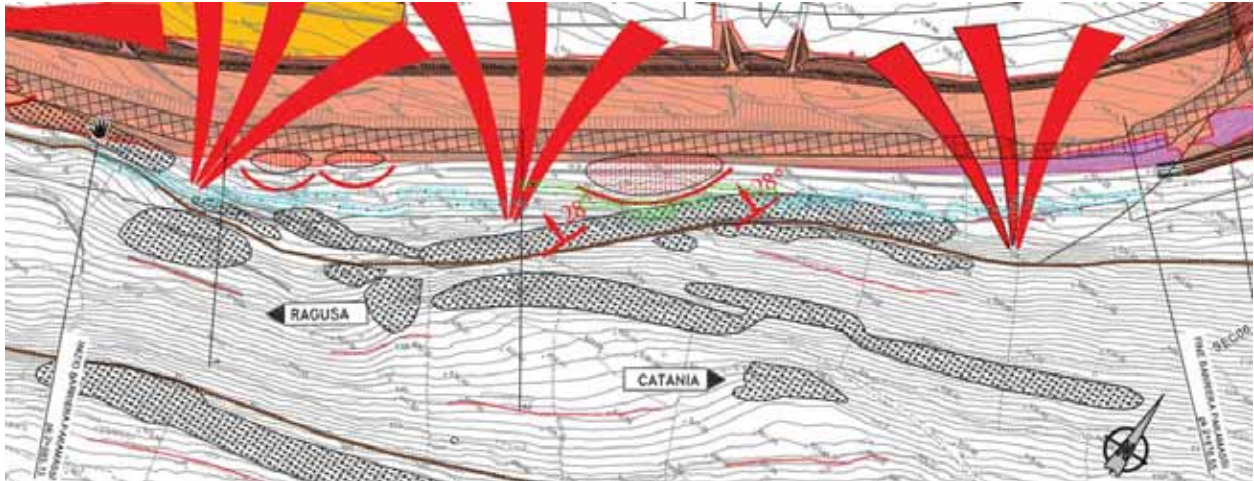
Stralcio della Sez 1 con ubicazione delle barriere paramassi.
